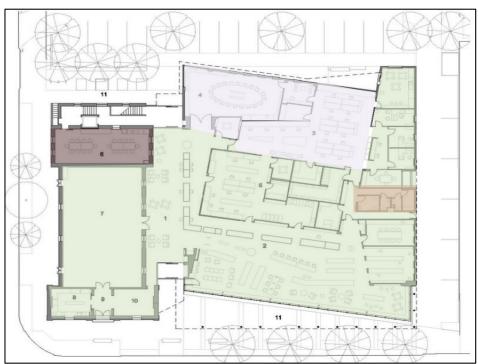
Planta baja del centro cívico y comunitario de Walkerville Fuente: archdaily
